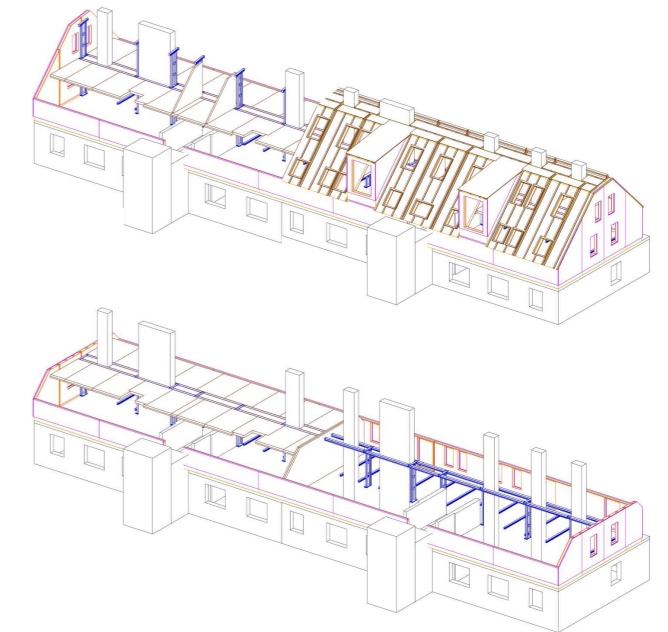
Entwurf einer Dachaufstockung Attic Adapt
